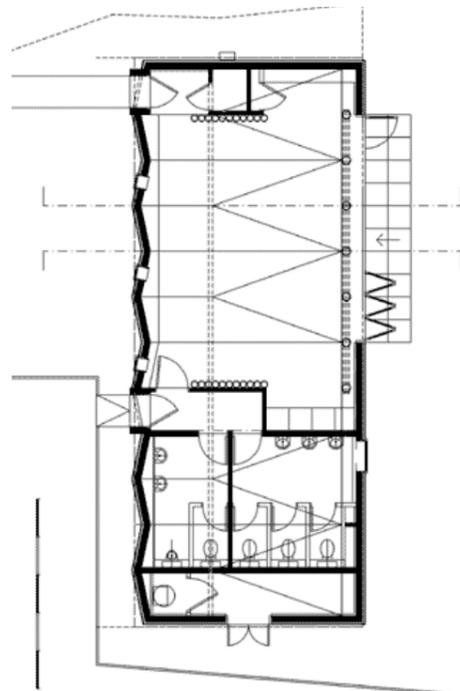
PIANTE DELLA WESTBOROUGH SCHOOL
